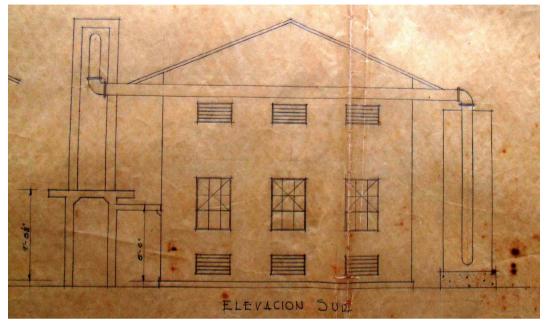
Planta Bisulfuro de Carbono - Elevación. Código 4981, 1946
